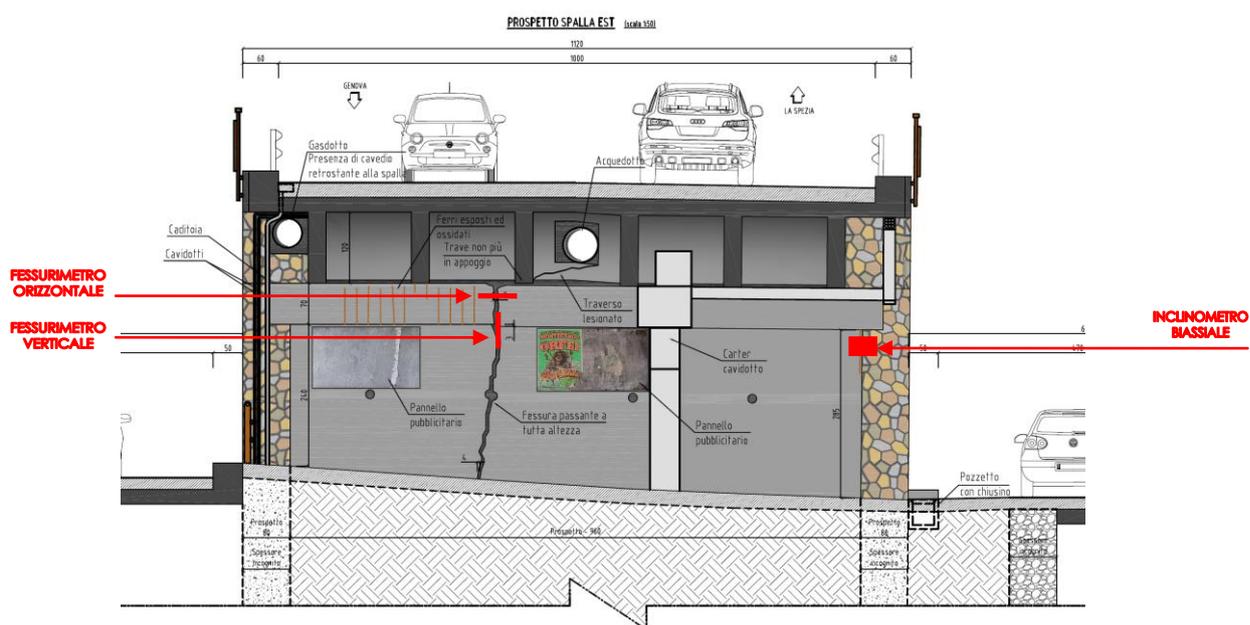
Prospetto spalla EST - Identificazione posizione fessurimetri ed inclinometro
